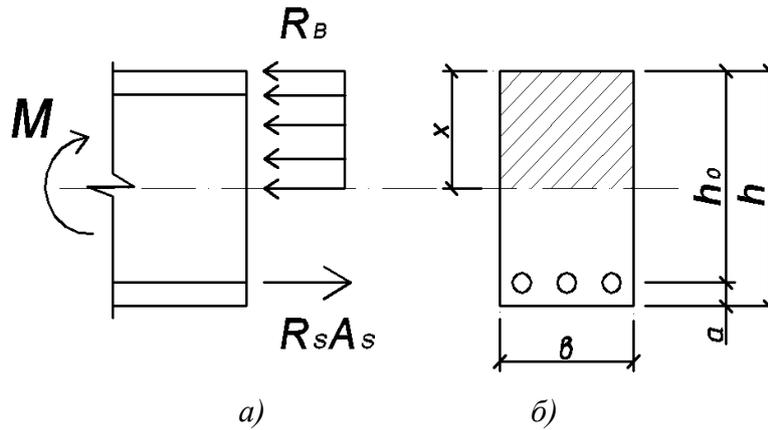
Балка прямоугольного сечения с одиночным армированием:
